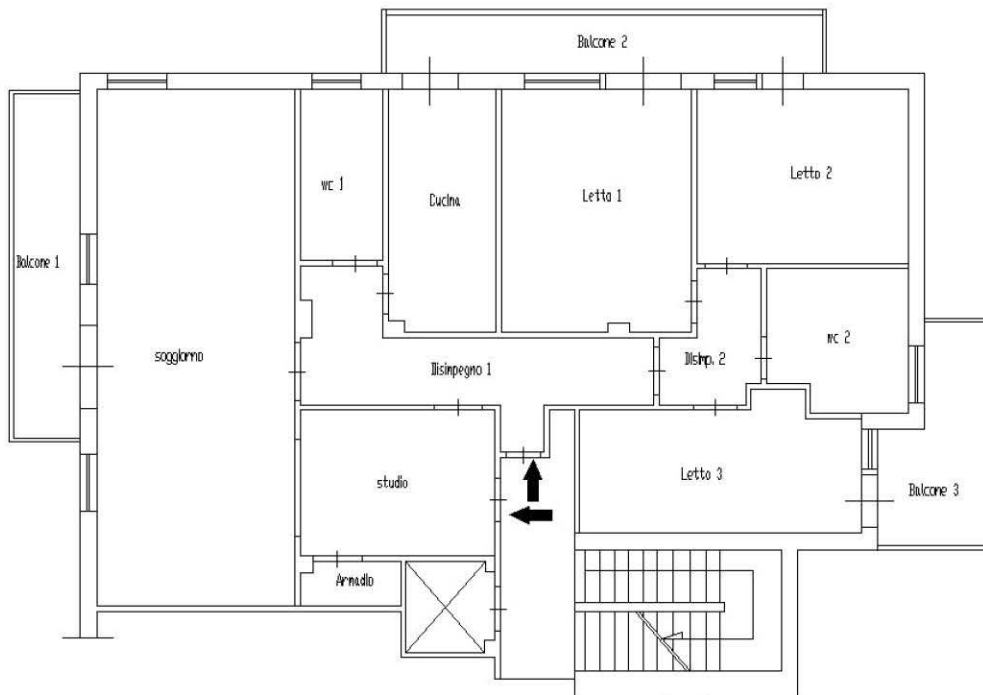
Planimetria dell'appartamento oggetto di pignoramento- interno 5
